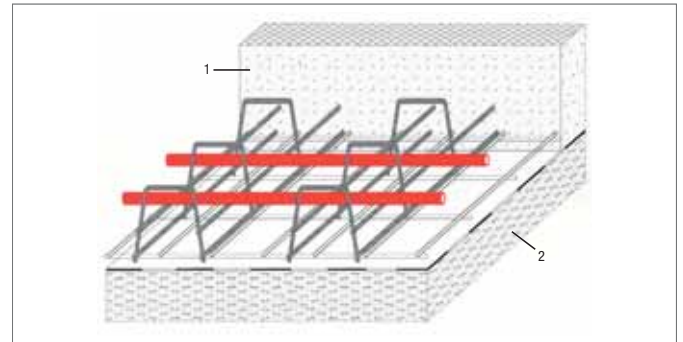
Solera de hormigón armado reforzado con fibras de acero; construcción estándar con tubos de calefacción montados sobre la malla de armado inferior
